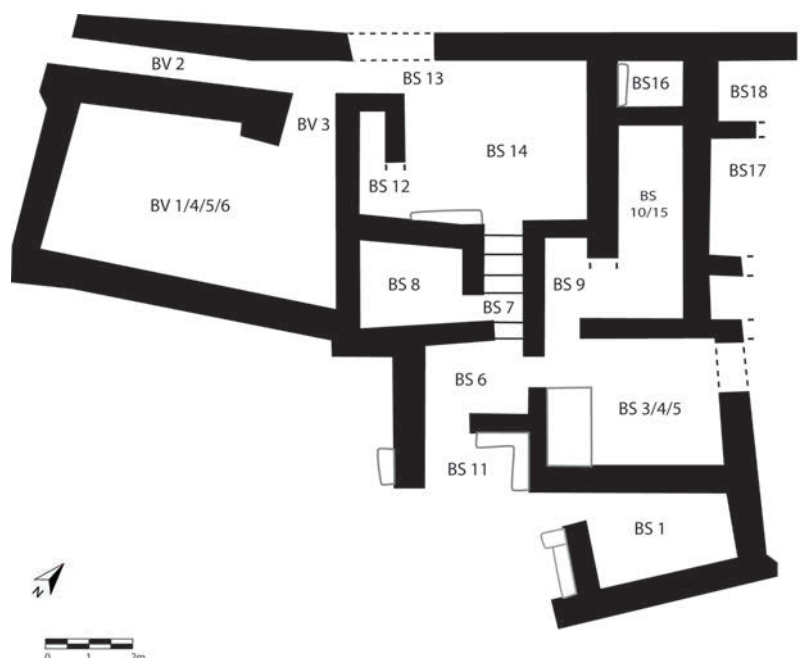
Planta de la *Casa de la Plaza* en Pseira.
